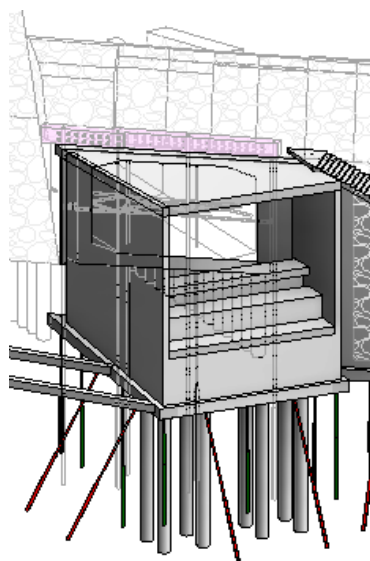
Vista 3D da solução definitiva da Fundação Indireta do Encontro Nascente
